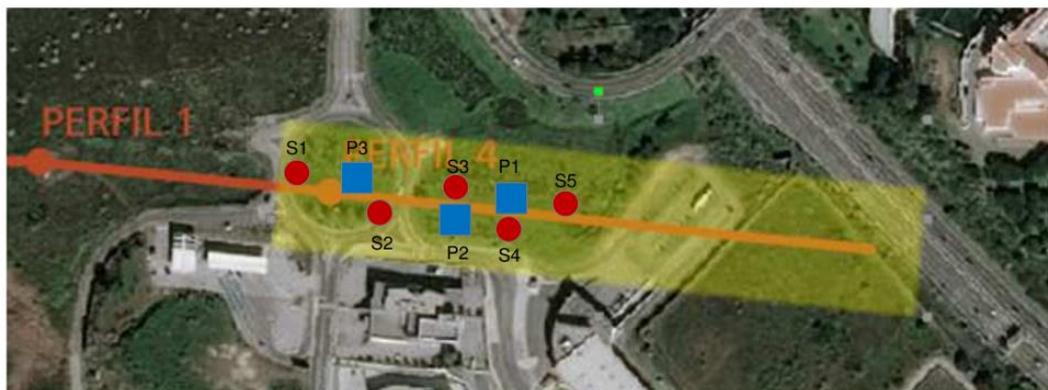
Planta da localização das sondagens e poços geotécnicos
